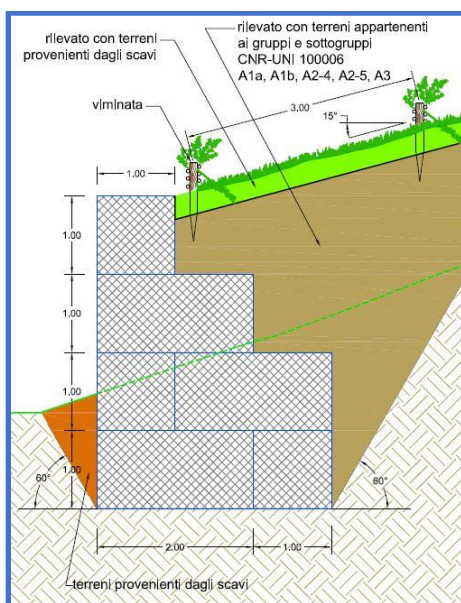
Zona intervento 2 – Sezione tipo dell'intervento
